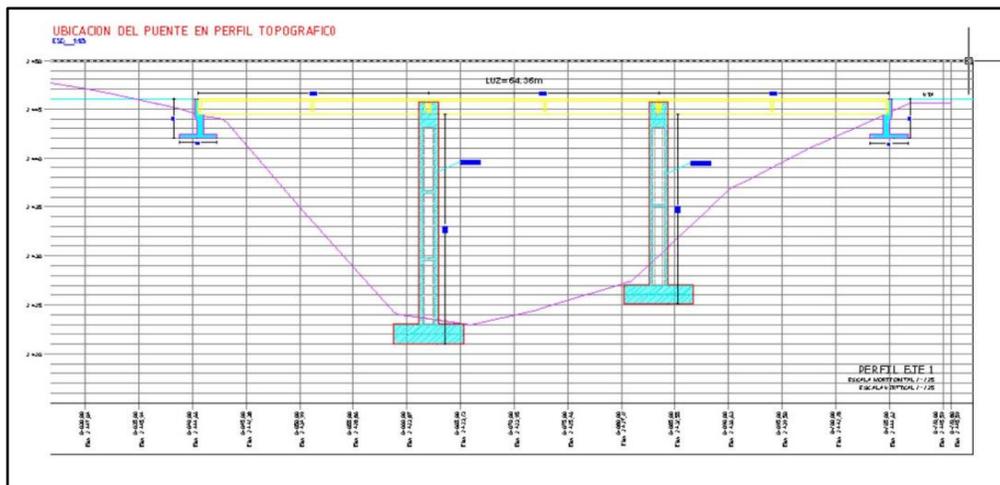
Ubicación de estribos y pilares centrales del puente (fuente: diseños del proyecto)
